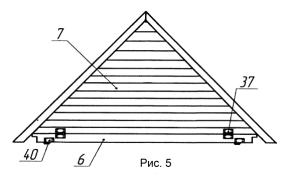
Фронтон двускатной крыши с поперечной балкой: 6-поперечная балка; 7-фронтон; 37-шарнир; 40-полушарнир.
